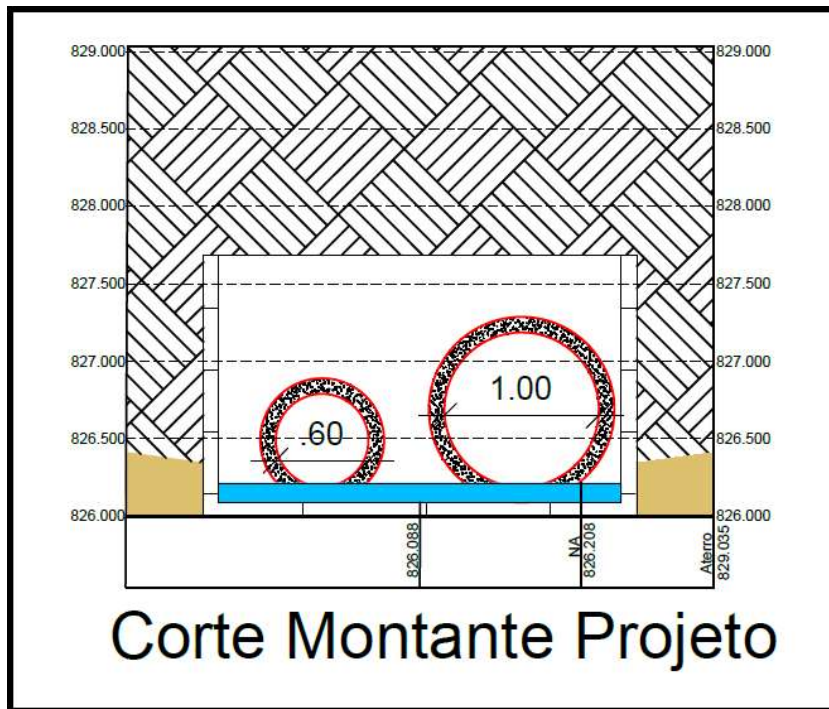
CORTE TRANSVERSAL FINAL #01
